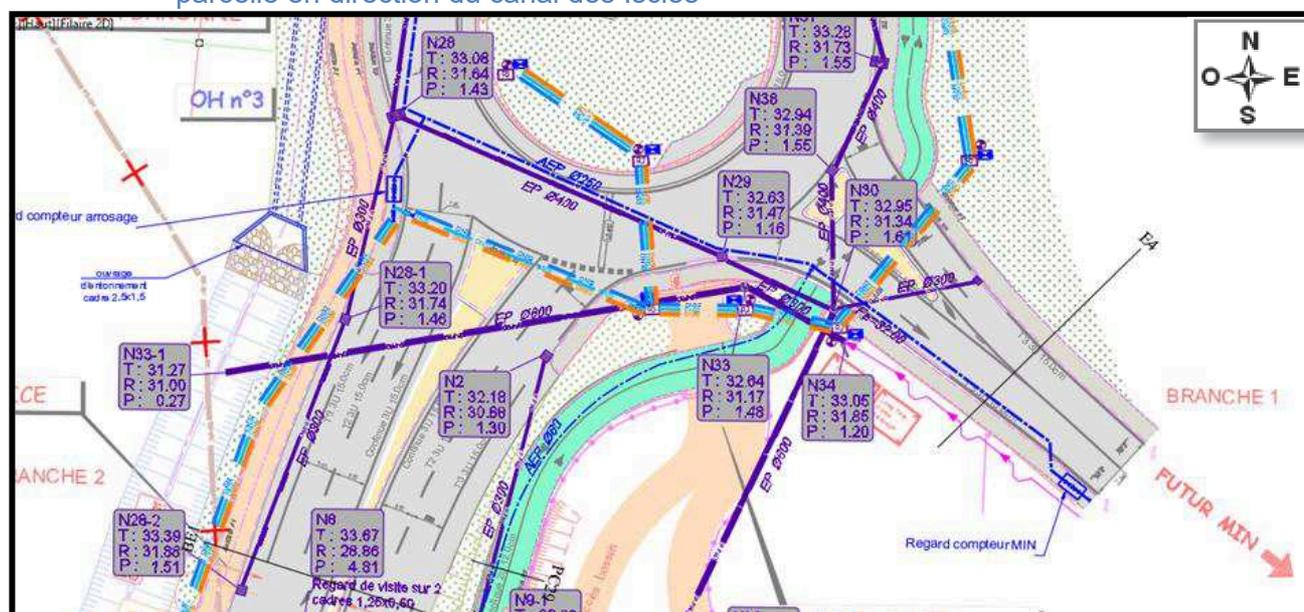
Extrait du plan du réseau pluvial du projet de giratoire de La Baronne
